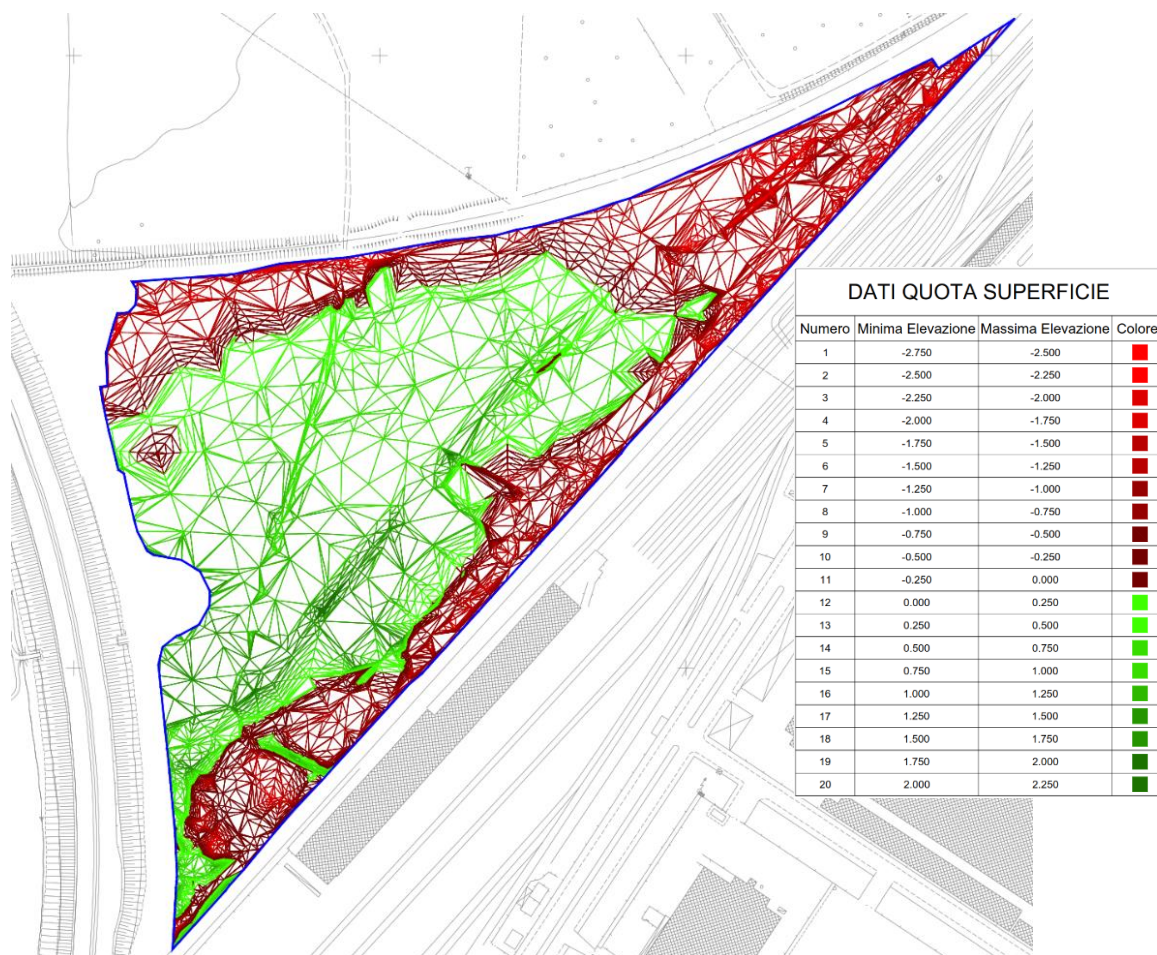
Stralcio della planimetria di rappresentazione degli scavi (in rosso) e dei riporti (in verde) rispetto allo stato di fatto (elaborato di PE 00_03_02_04).
